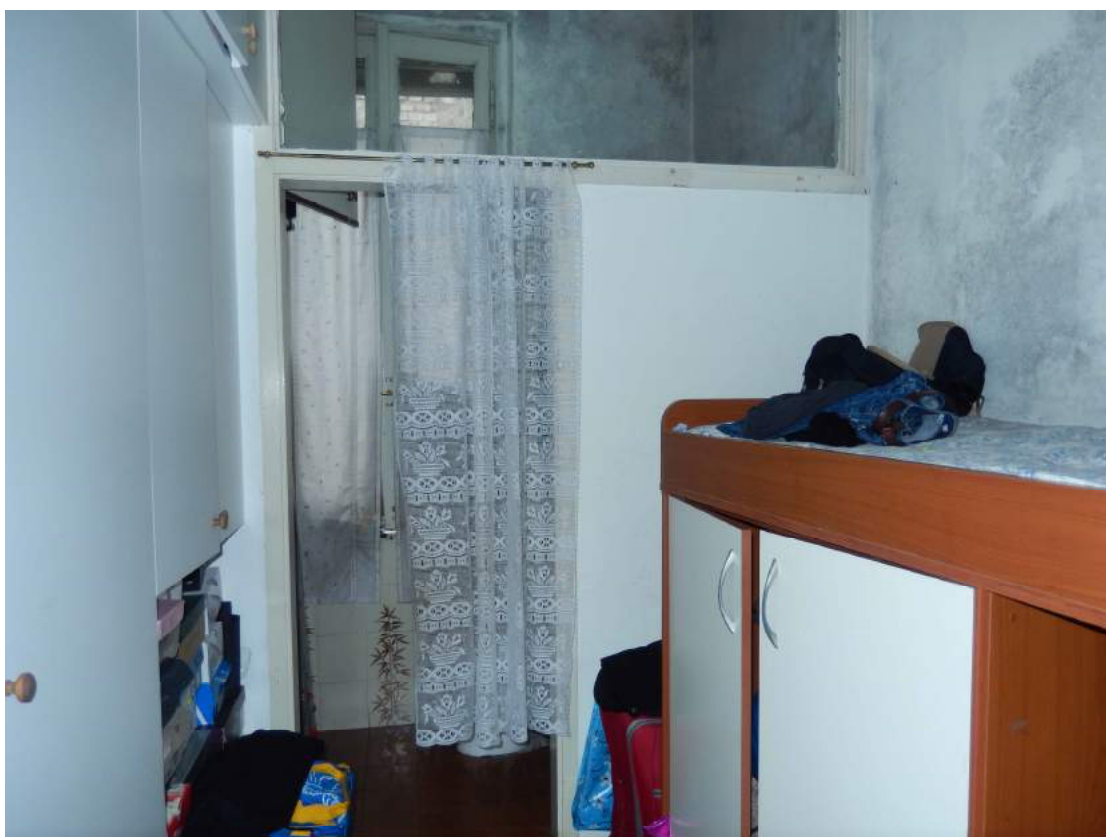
Vista parziale della cameretta. Sul fondo il "locale doccia".
